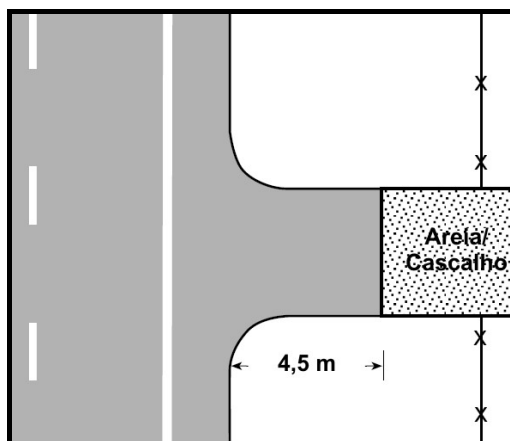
Esquemático de pavimentação de trecho numa via de entrada.
